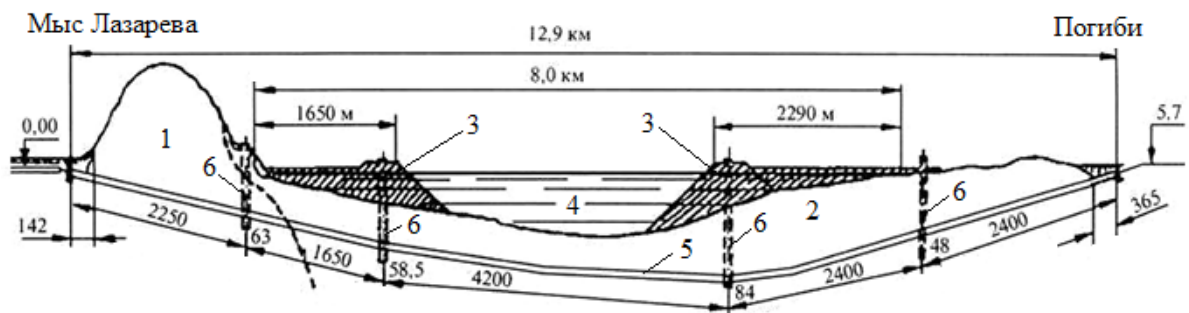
Продольный разрез проектируемого тоннельного пересечения:
